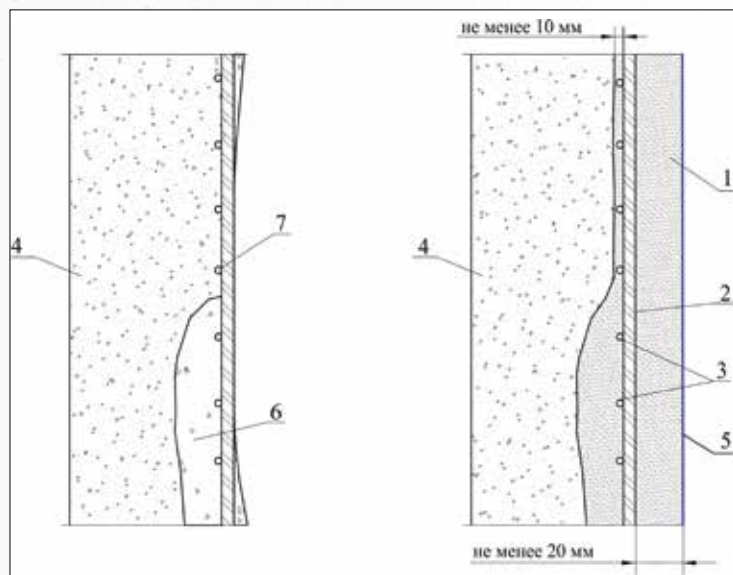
Схема восстановления защитного слоя арматуры и гидроизоляции железобетонных конструкций:
